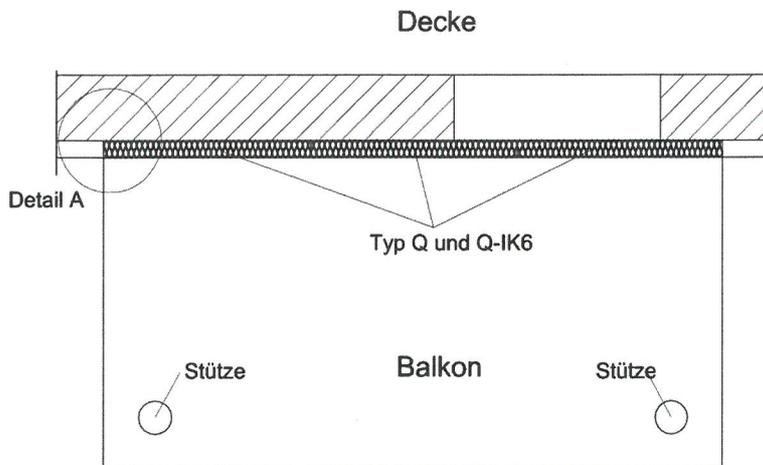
Grundriss: Einbausituation Schöck Isokorb Typ Q und Q-IK6
